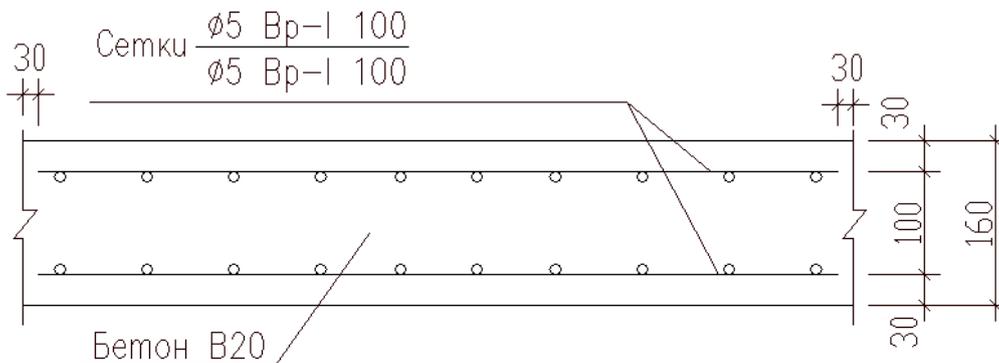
Расположение арматурной сетки в бетонном перекрытии
